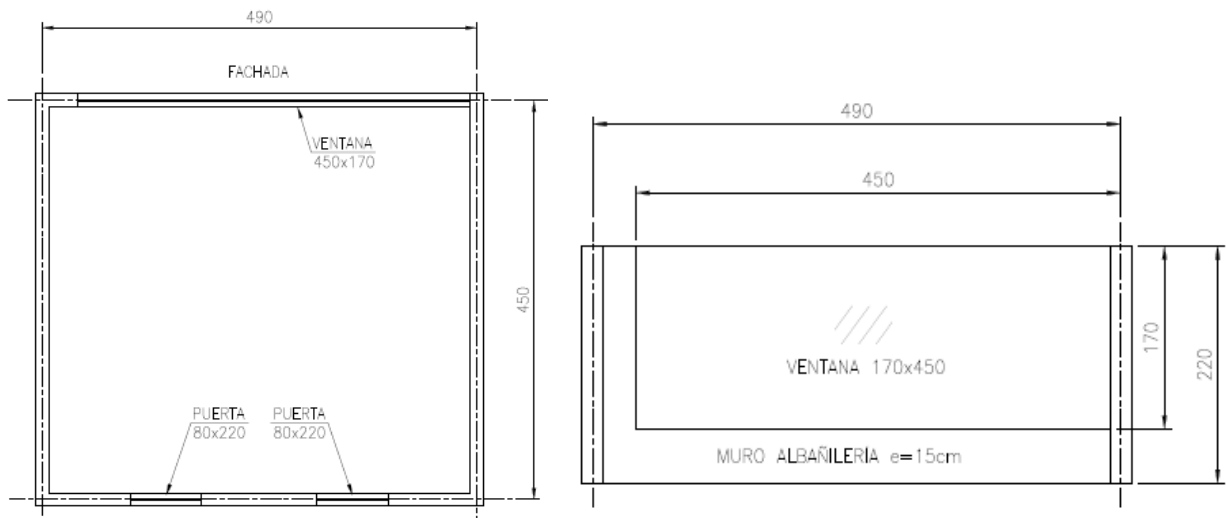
Vista en planta del recinto utilizado para el ensayo.
